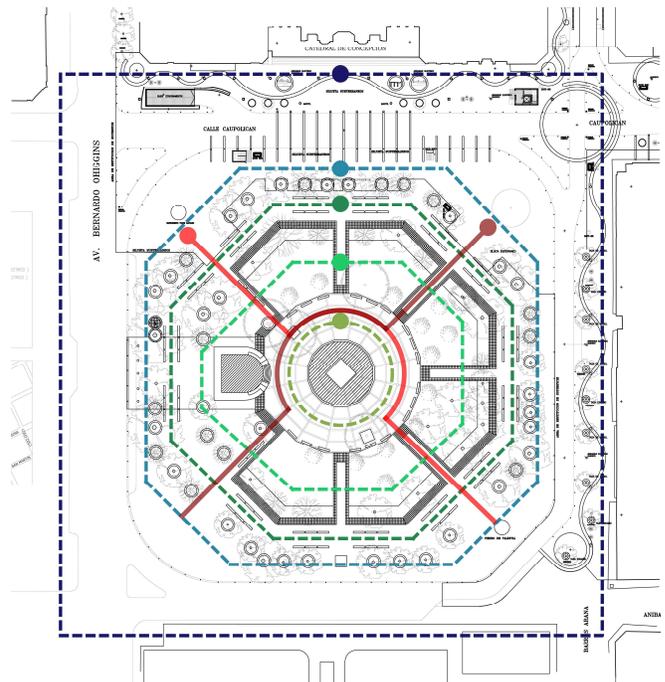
Planta con recorridos determinados en discusión de equipo investigador para primer ensayo. Fuente: Elaboración propia
